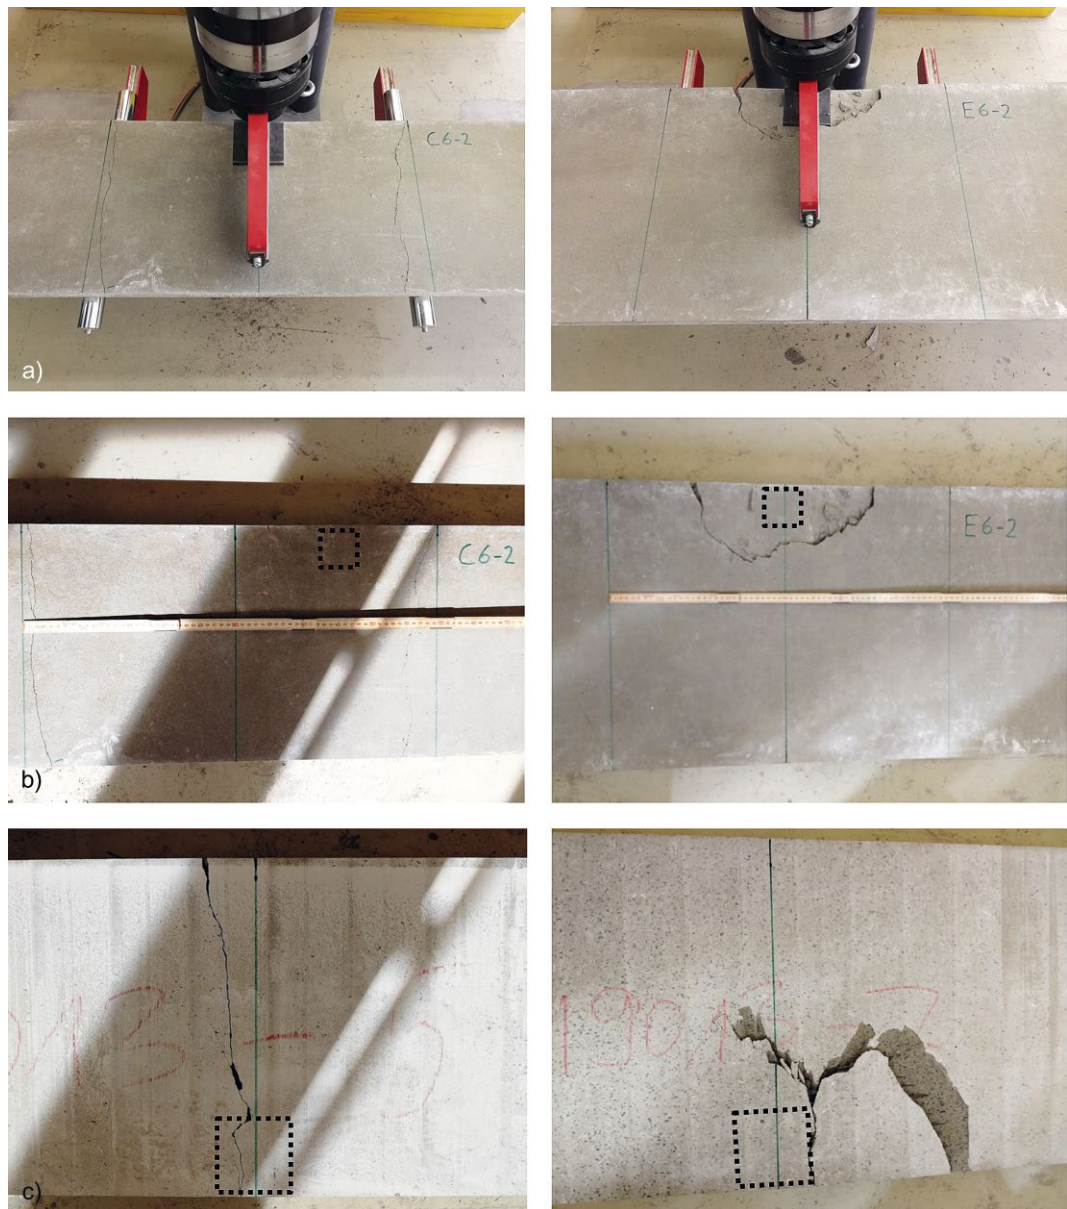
Links: 350 mm breiter Prüfkörper C6-2 mit typischem Biegeversagen; a) Prüfkörper bei Bruch; b) Oberseite nach Bruch mit Biegerissen bei Auflagern; c) Unterseite nach Bruch mit Biegeriss unter Last; rechts: 500 mm breiter Prüfkörper E6-2 mit lokalem Biegeversagen und anschließendem Schubbruch; a) Prüfkörper bei Bruch; b) Oberseite nach Bruch mit Schubrissen; c) Unterseite nach Bruch
